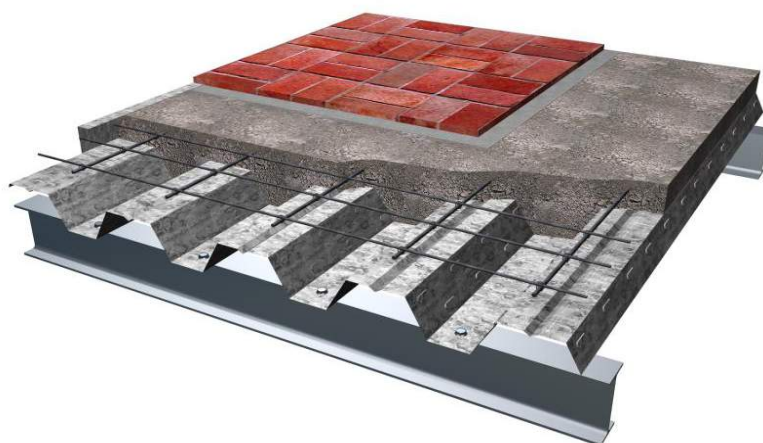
Ejemplo de adherencia de perfiles colaborantes en chapa de hormigón.
